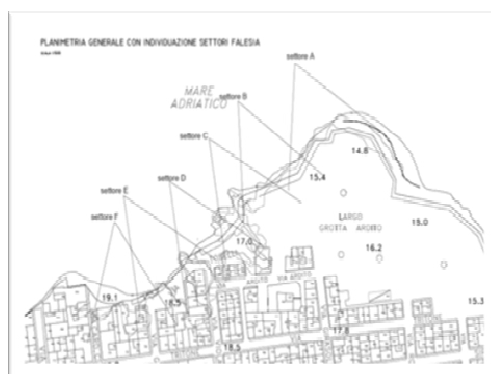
Planimetria generale con individuazione settore falesia (Cfr. TAV 9)
